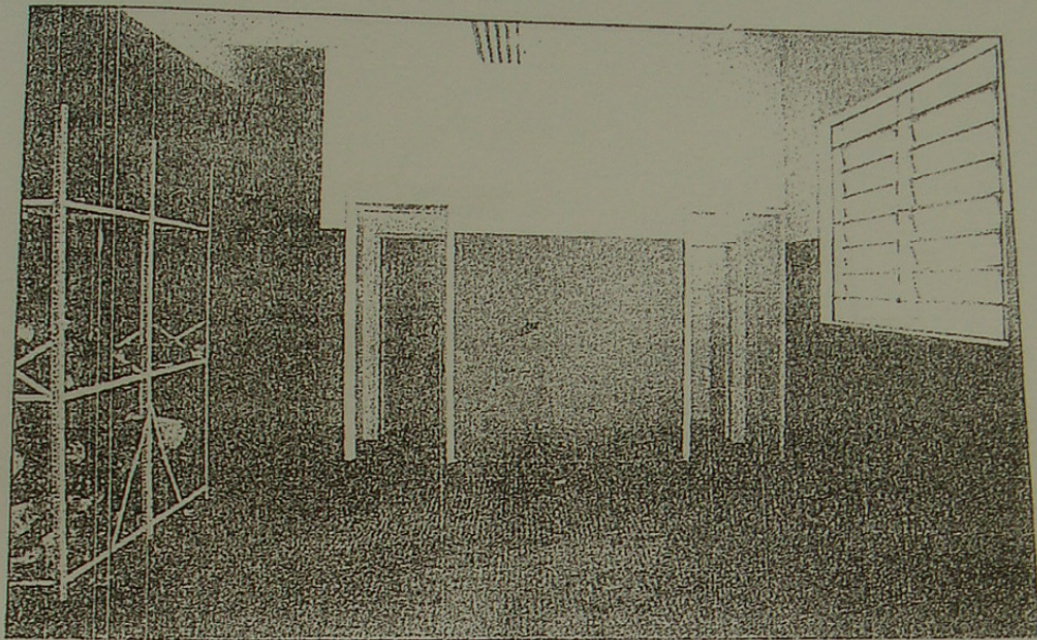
/9 - Detalhe do pavimento térreo do Galpão 1.
